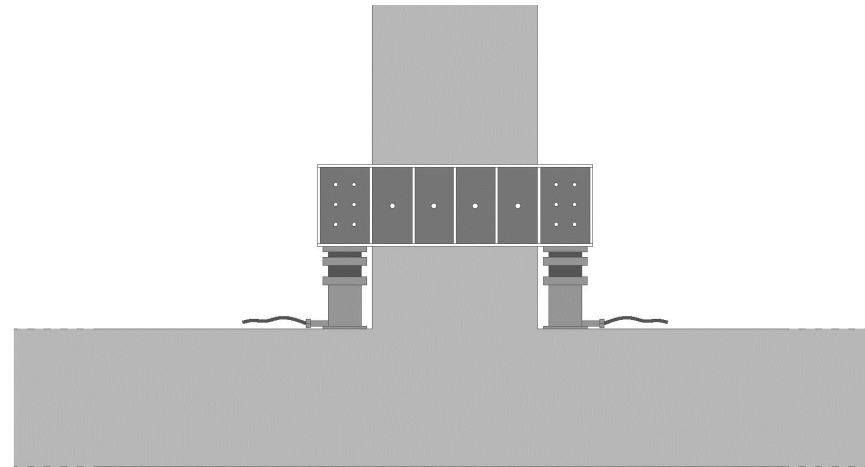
17 – Posa di martinetti idraulici tra la base dei pilastri e la carpenteria
